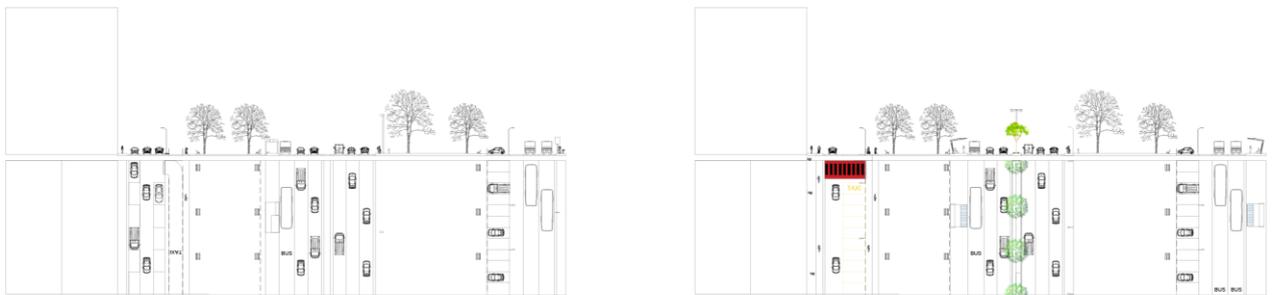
Sezione e Pianta, Piazza sofia Pre e Post intervento.
